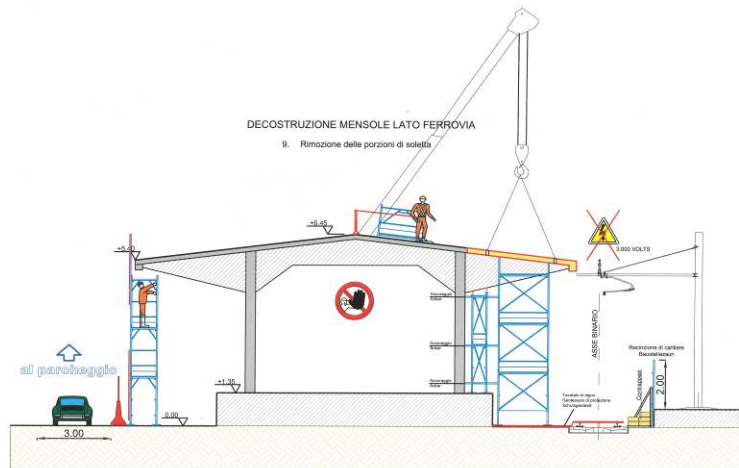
Sezione Demolizione Edificio A9 – Rimozione porzione di soletta
